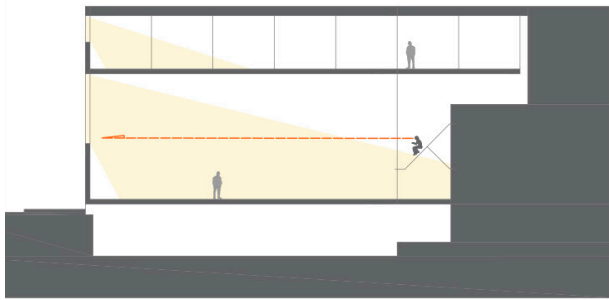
Aulas del Gimnasio Maravillas. Miradores en la planta alta.
